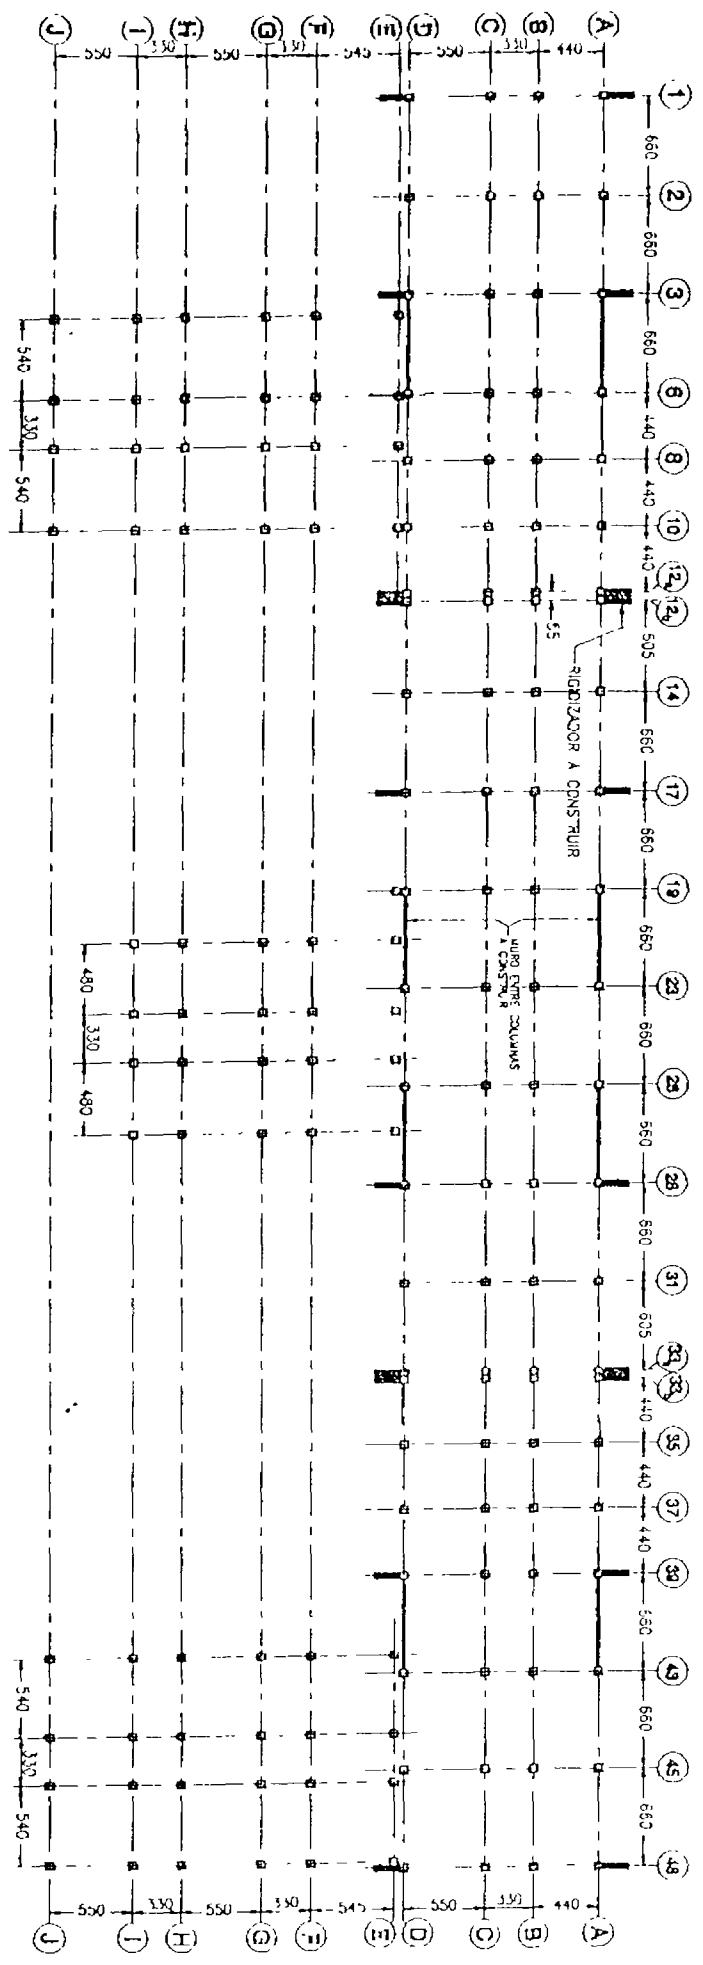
ALTERNATIVA 2 DE REFORZAMIENTO: MUROS LONGITUDINALES ENTRE COLUMNAS
